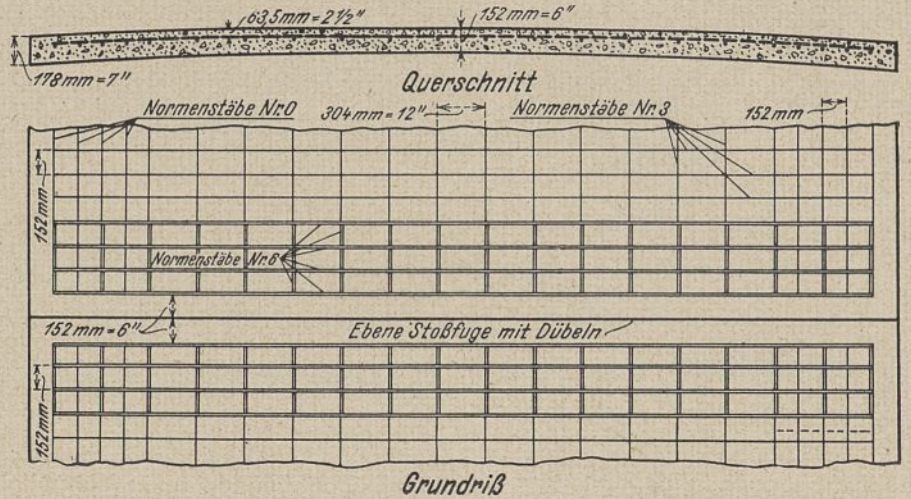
Betondecke mit Bewehrung der Oberfläche. (Nord Carolina).
